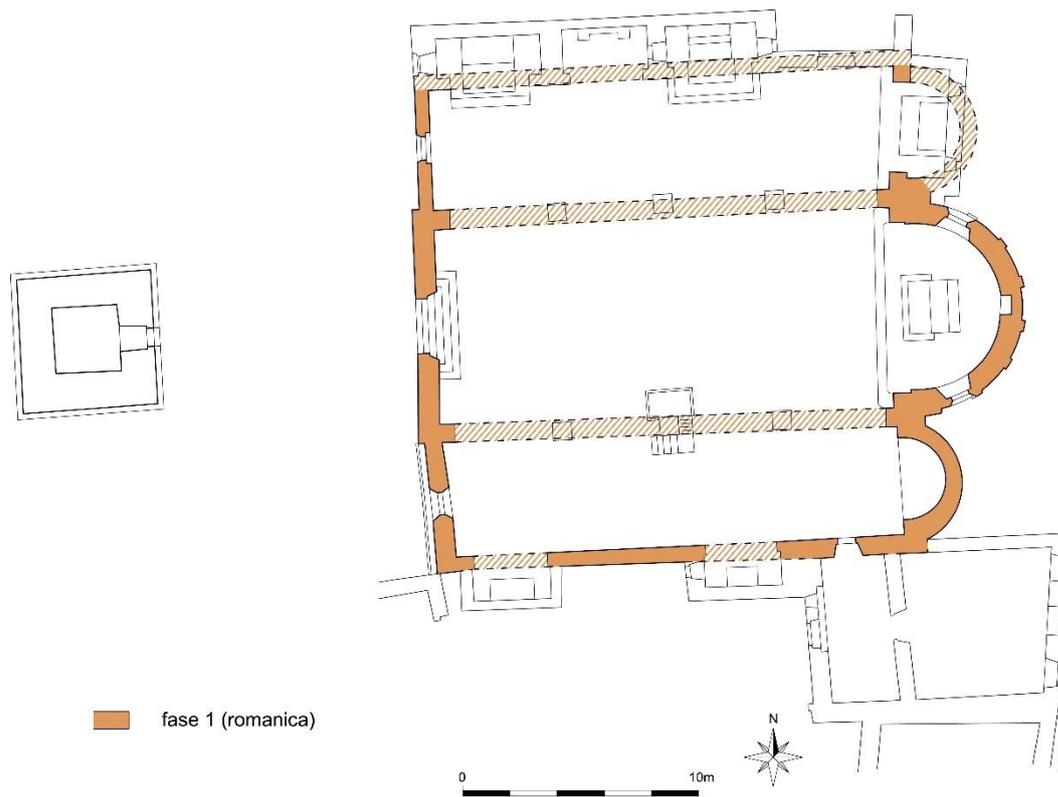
Planimetria della prime fasi in alzato della Pieve³³
